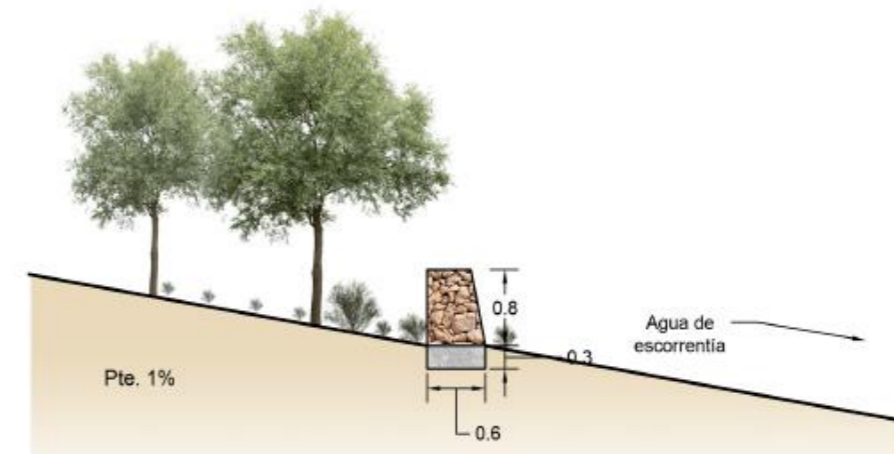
Sección de modelo de muro de piedra en seco propuesto.
